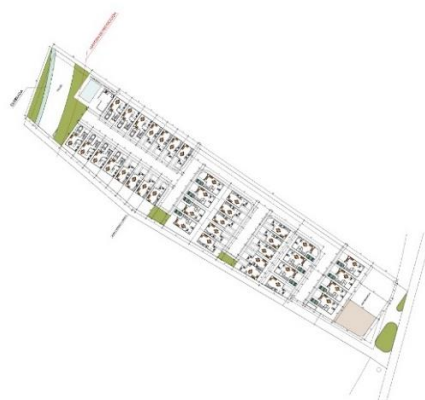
Plan arquitectónico proyecto "Portón del Sol"
